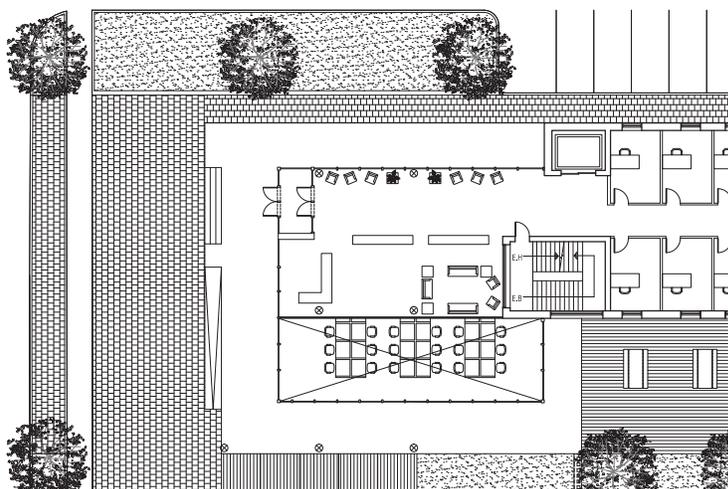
Extrait du plan du rez-de-chaussée_Entrée principale / Vanessa Vallée / 2014
